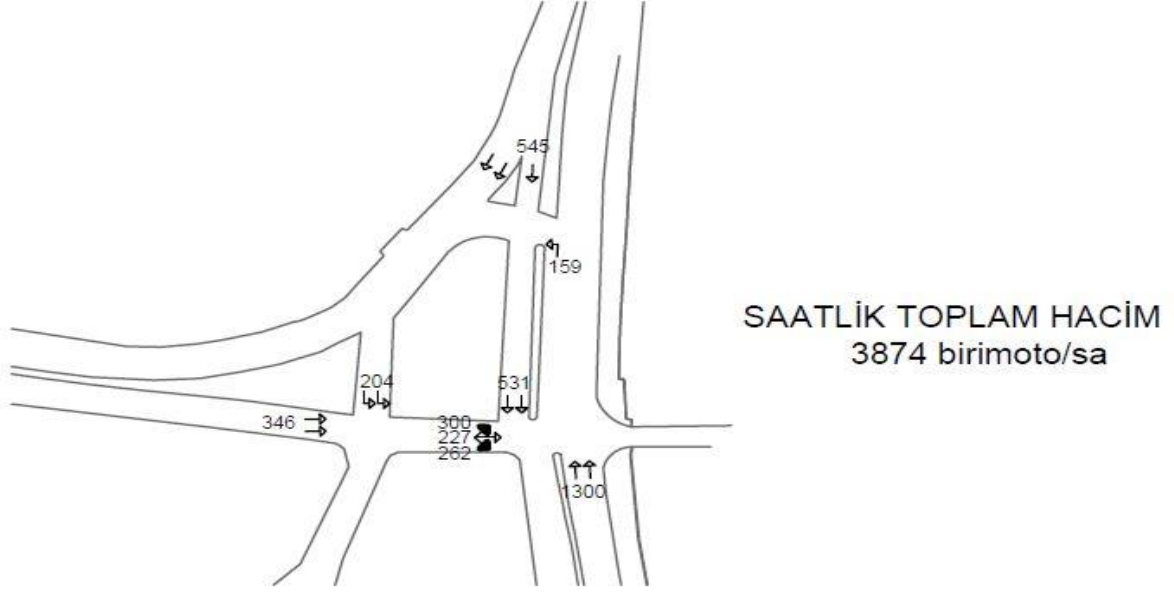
Belgradkapı Üst Yapı Planı
